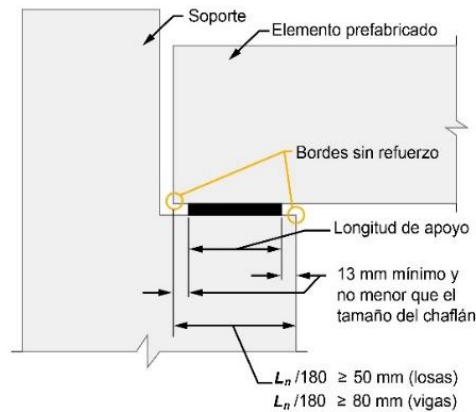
Longitud de una conexión de apoyo (adaptada de ACI CODE-318-19)
